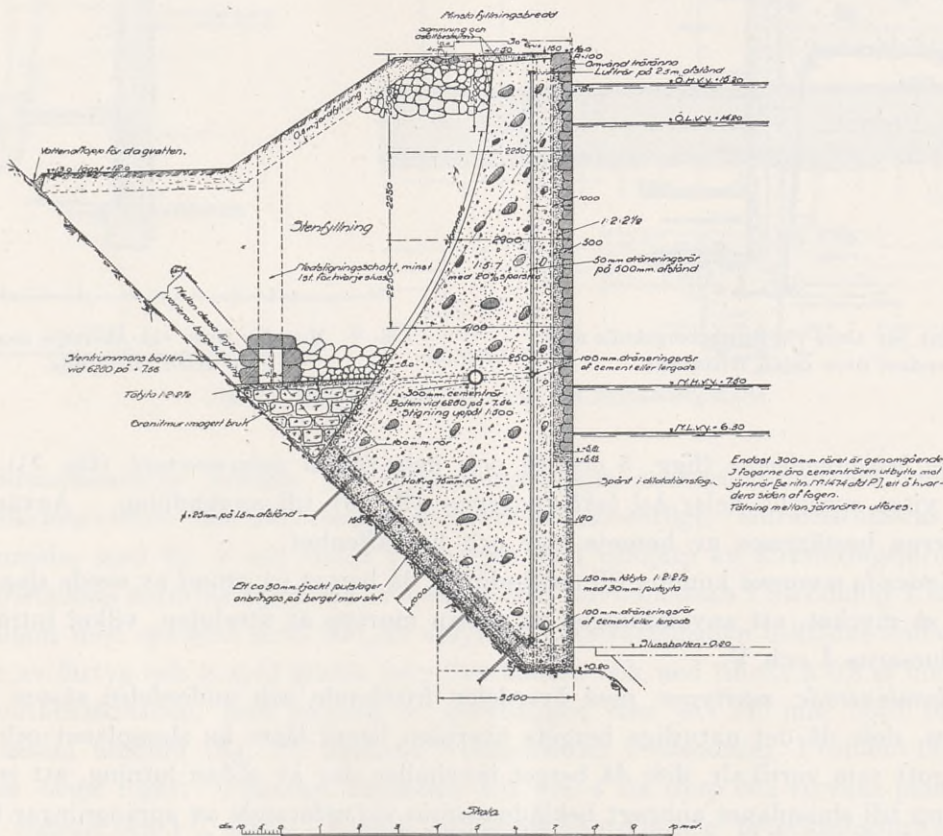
Fristående mur för nedersta slussen i slussstrappan.
